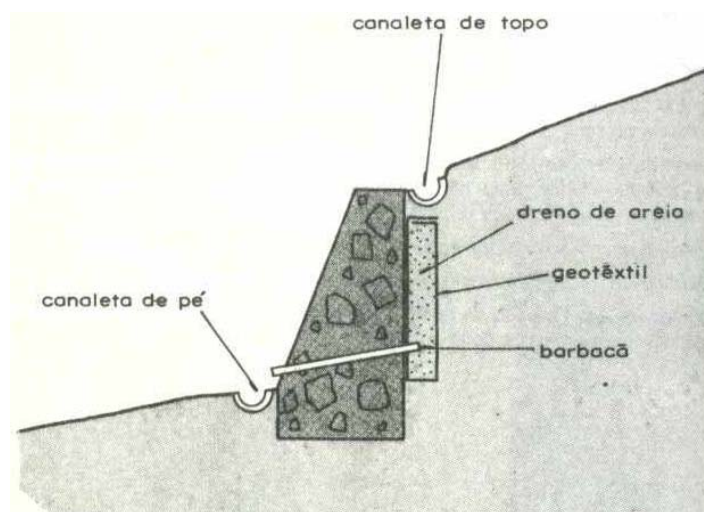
Muro de concreto ciclópico (CUNHA, 1991)
